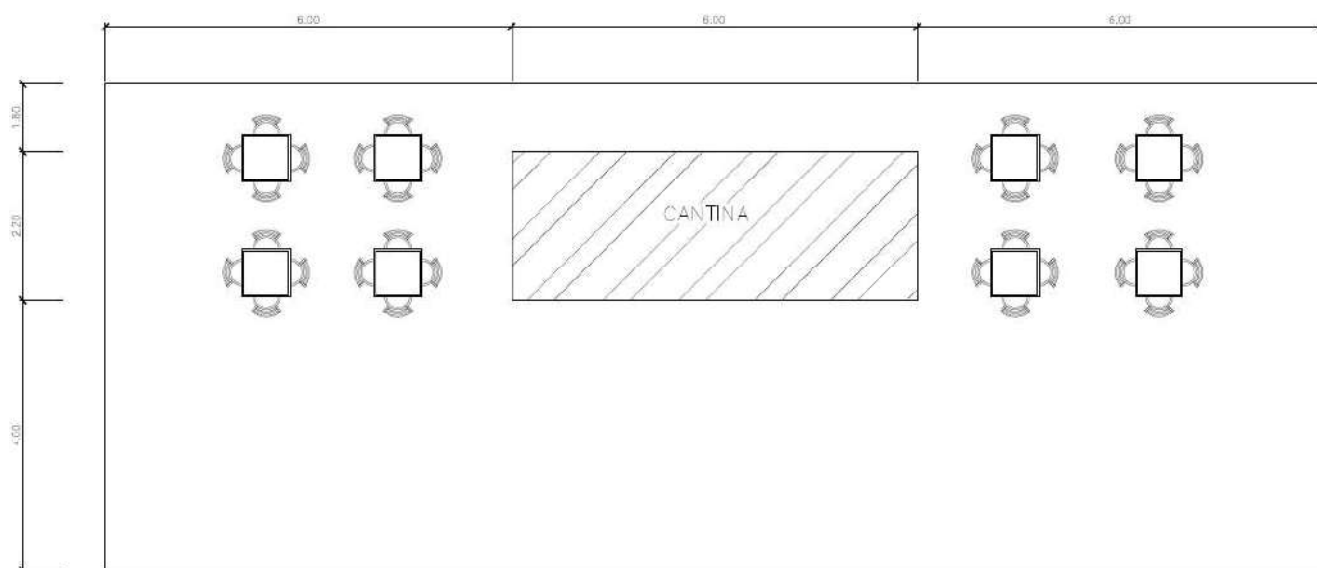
Planta baixa do terreno SP020165B0176. (Fonte: Própria 27/01/2026).
